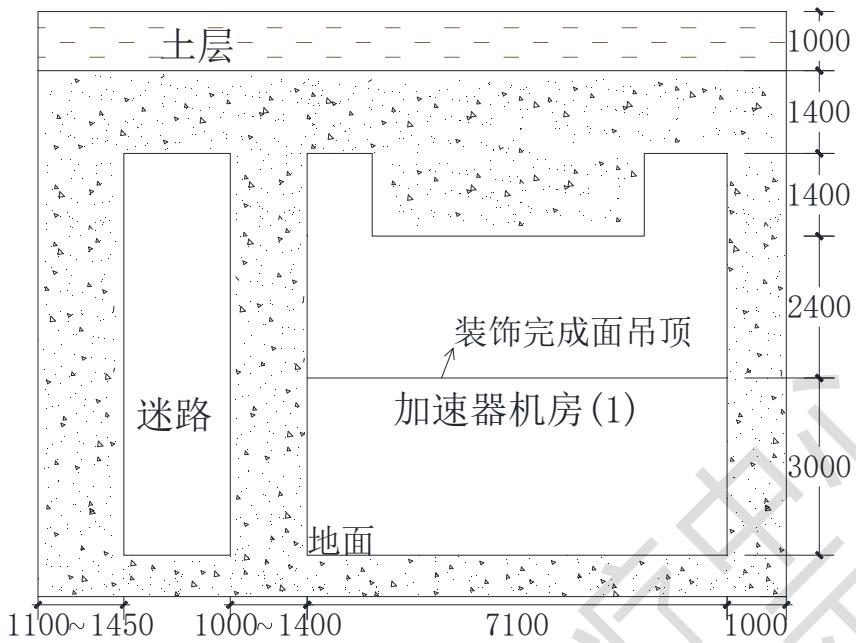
加速器机房屏蔽示意剖面图（剖面 2-2）（单位：mm）
